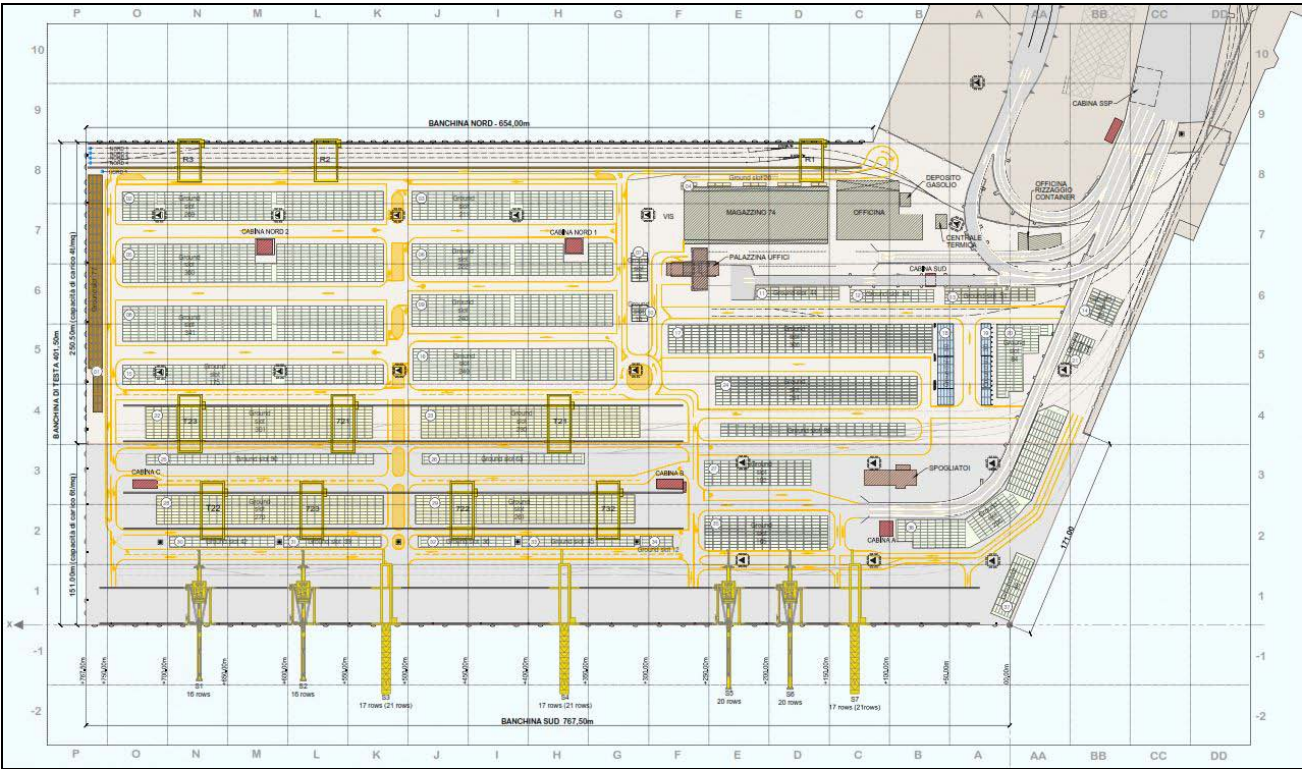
Planimetria funzionale del Molo VII-Stato di fatto
